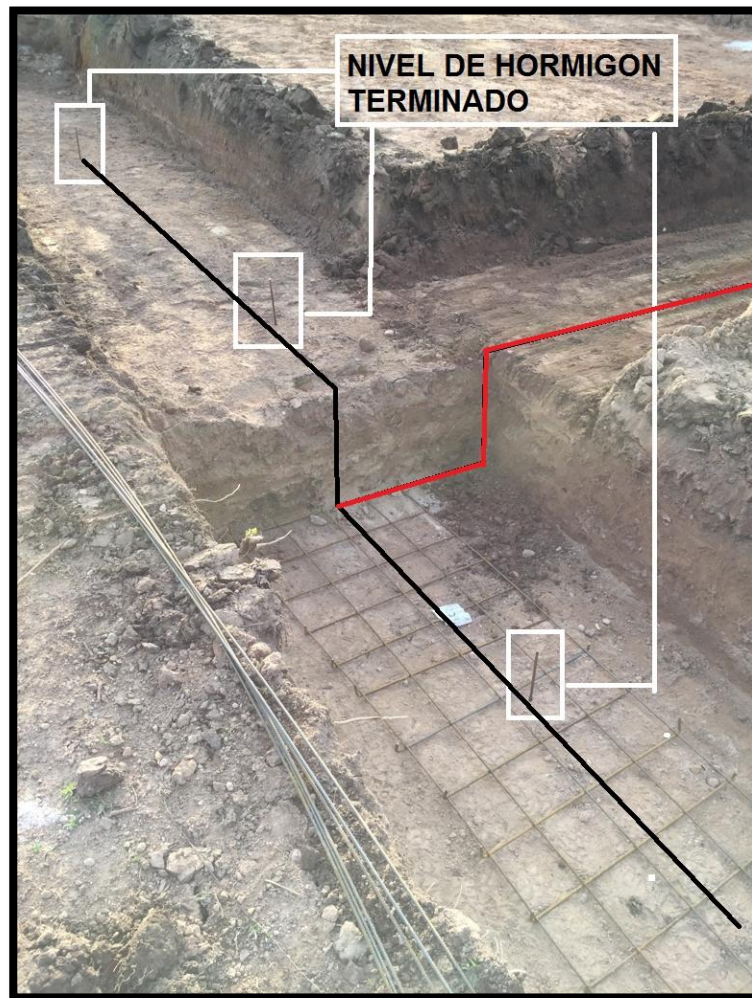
Excavación de muros y nivel de hormigón terminado replanteado.
